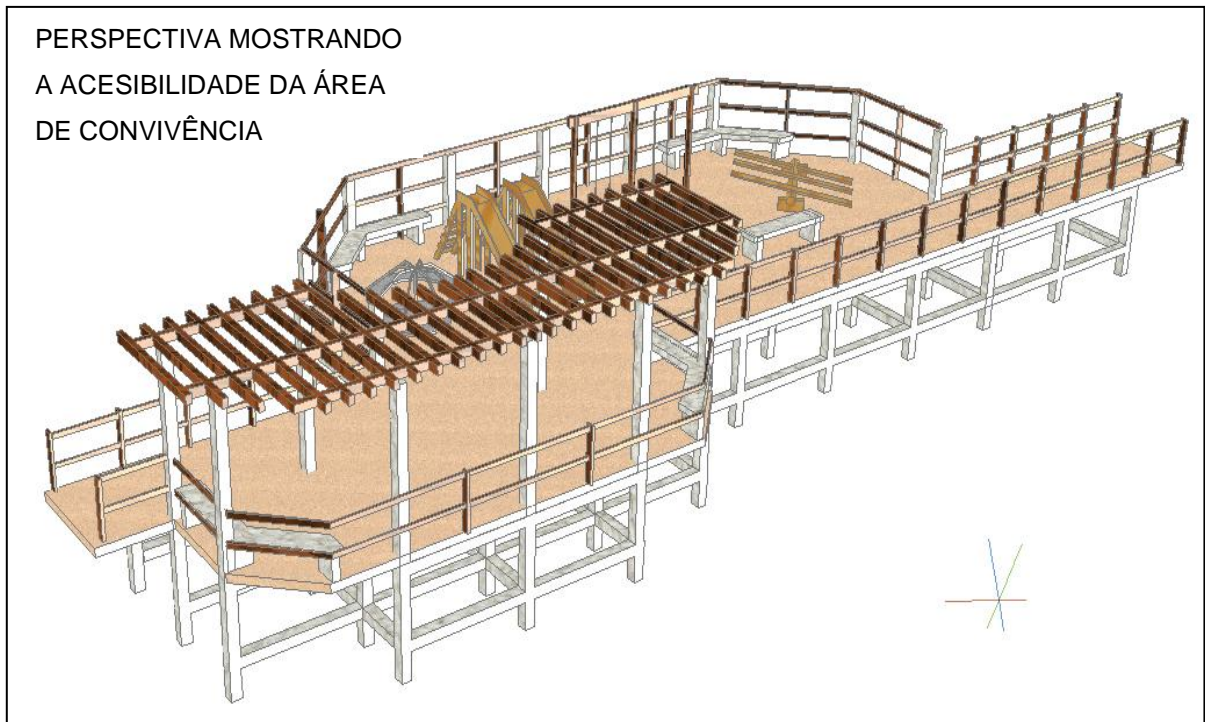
Projeto do Complexo de Entretenimento e lazer: Pracinha.
